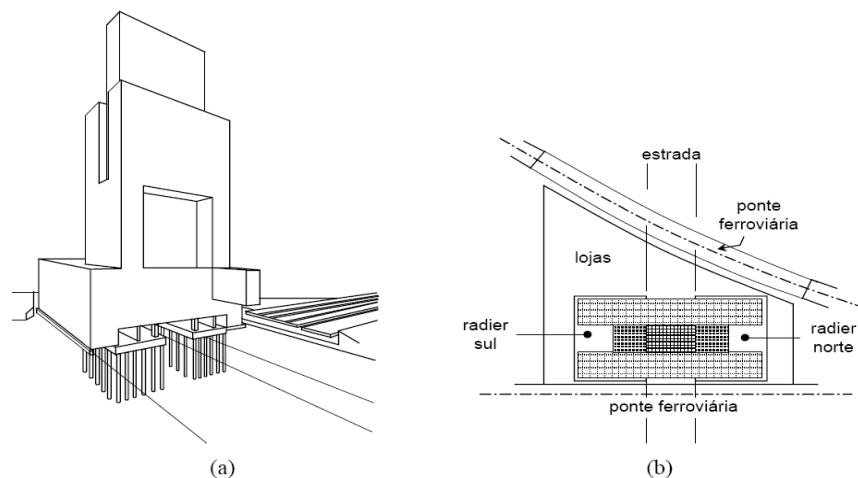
Radier estaqueado em argila de Frankfurt: (a) vista isométrica esquemática da fundação e superestrutura; (b) vista em planta (modificado - Sommer et al., 1985).
